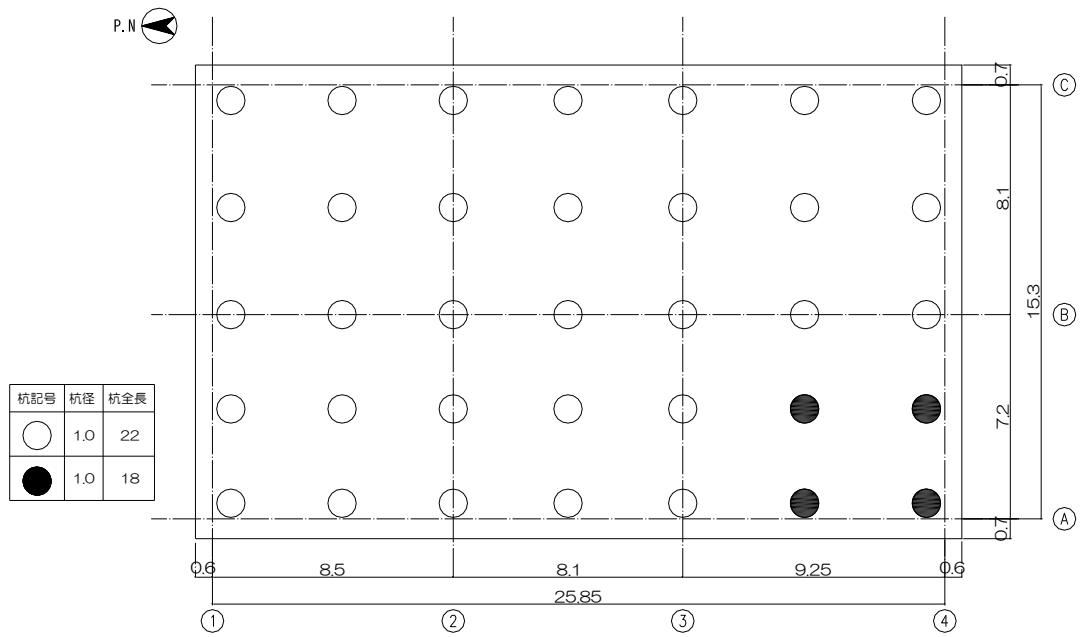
杭配置図 (G.L. -8.75) (単位 : m)
